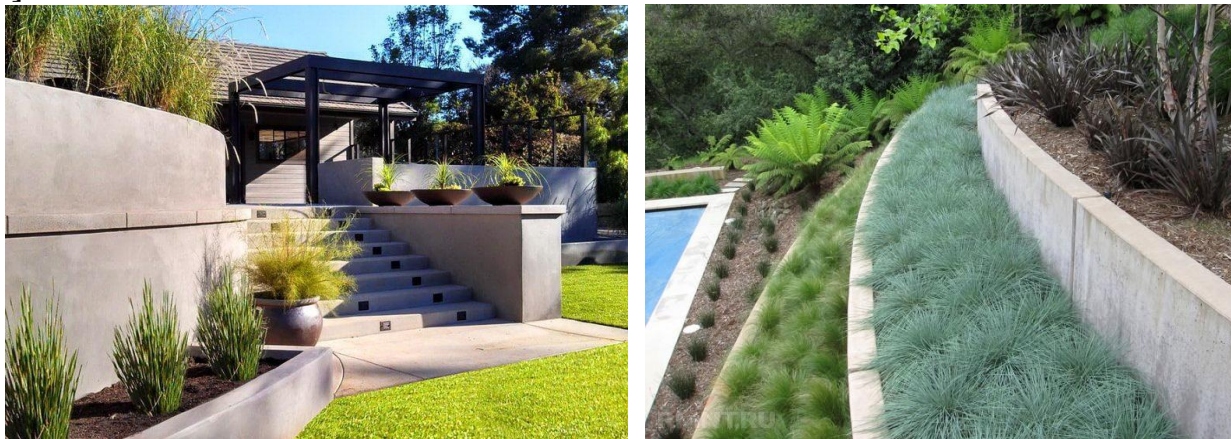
, 9 Варианты подпорных стенок из бетона [7, 4]
